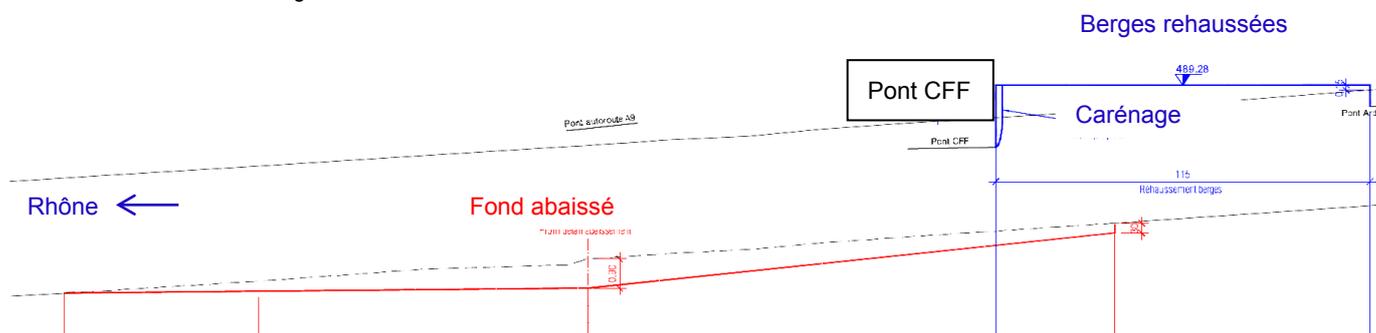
Profil en long de la Lizerne avec fond abaissé, nouveau pont CFF et berges rehaussées
